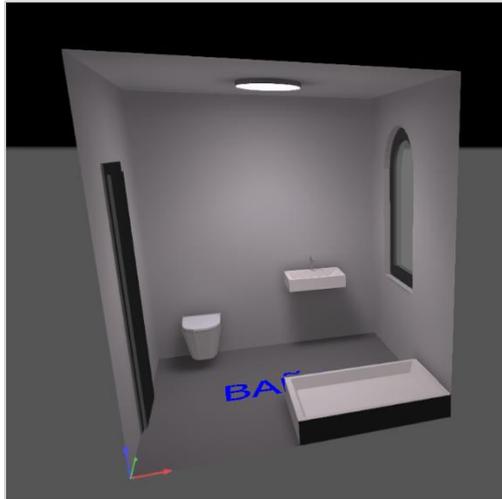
Situación luminarias del baño de la planta alta (fuente propia).
